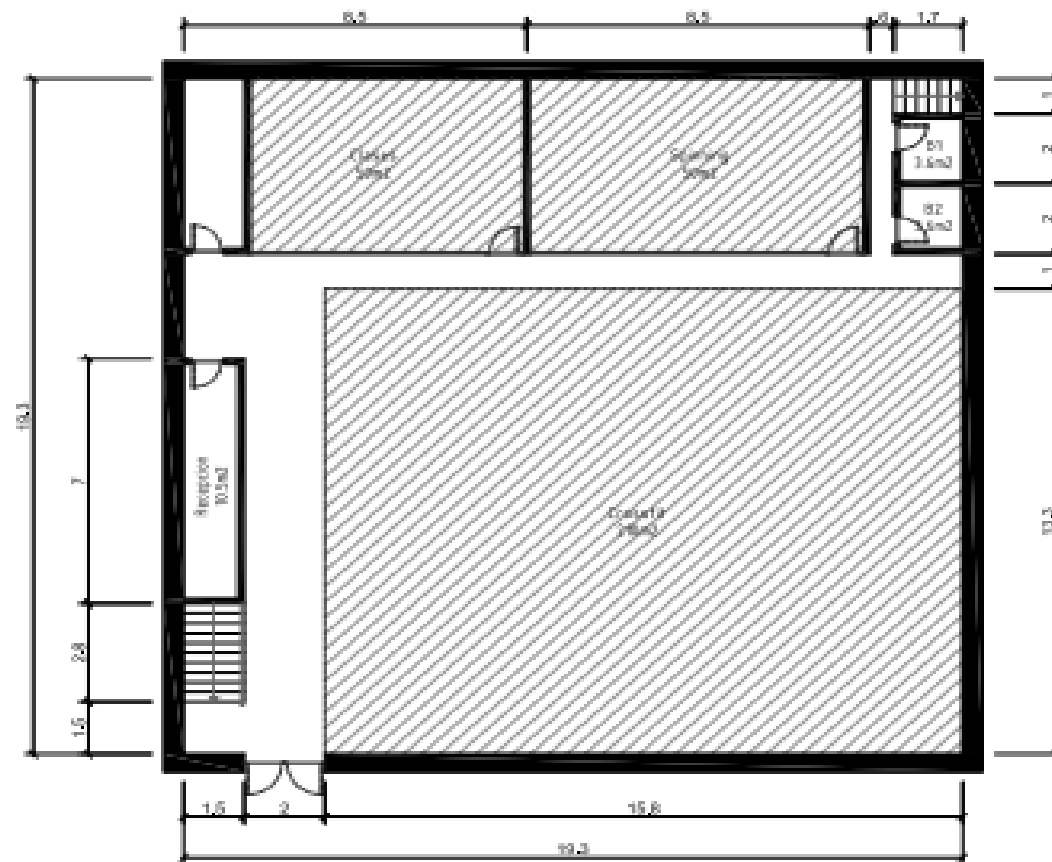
Plano planta principal. <<Fuente. Elaboración propia>>
